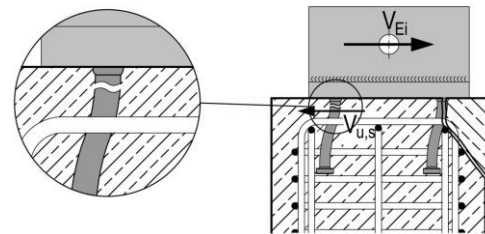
Kombiniertes Beton- und Stahlversagen durch Lastumlagerungen im Anschluss
